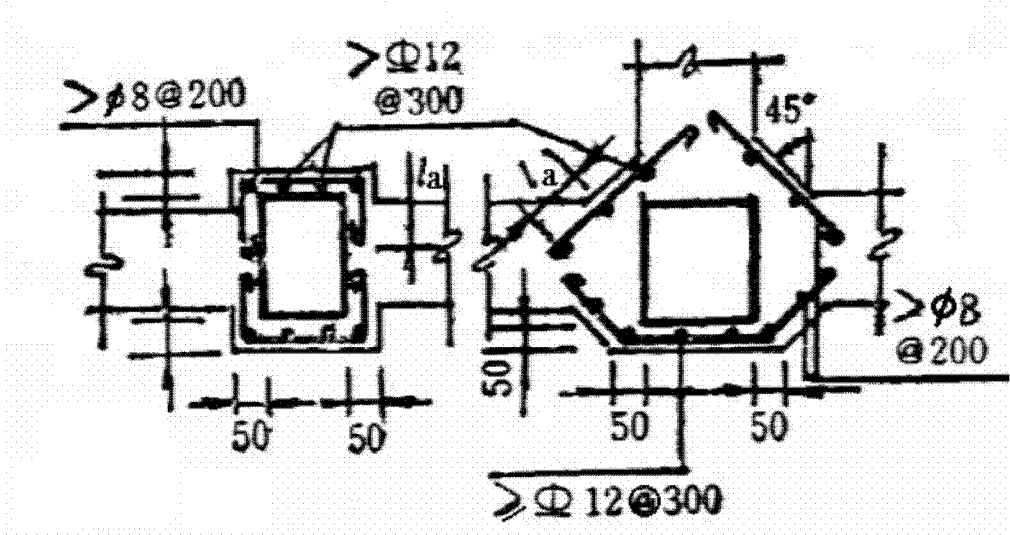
1 筏形基础梁与上部结构柱的连接平面
